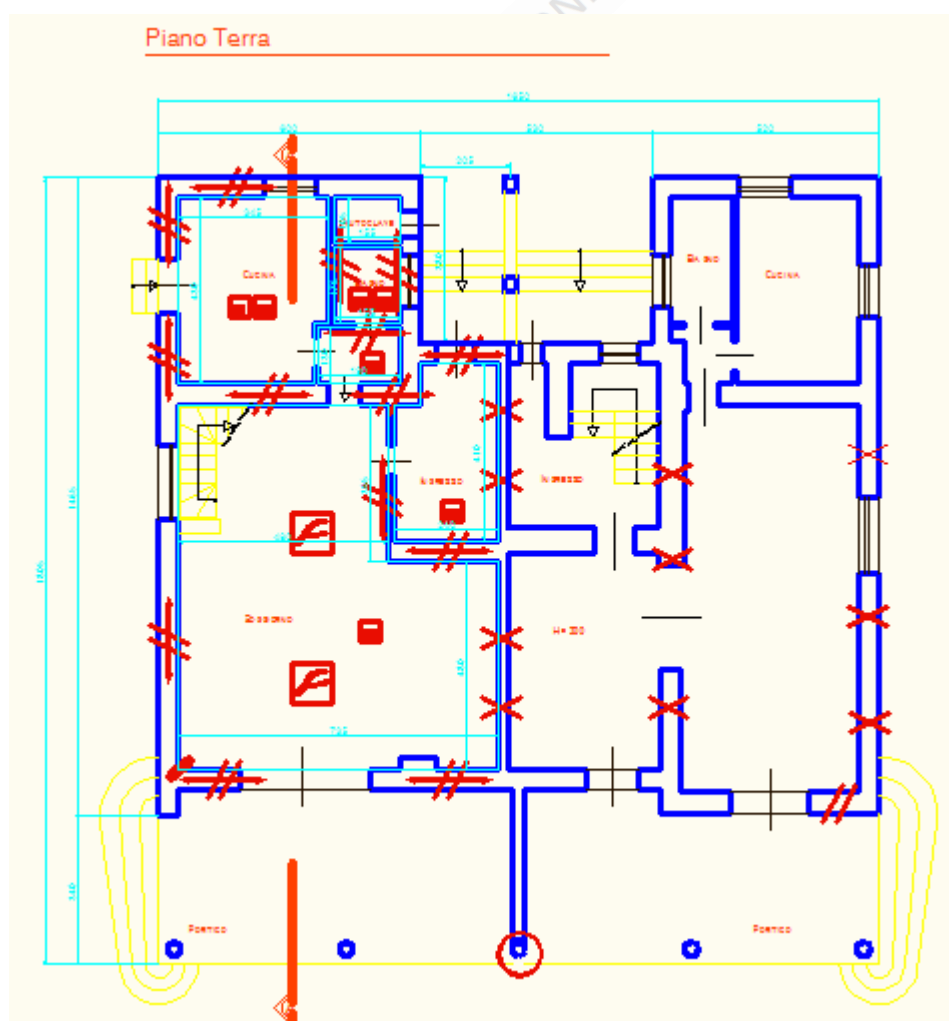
Planimetria del piano terra in cui sono riportati i danni subiti dalla struttura.
